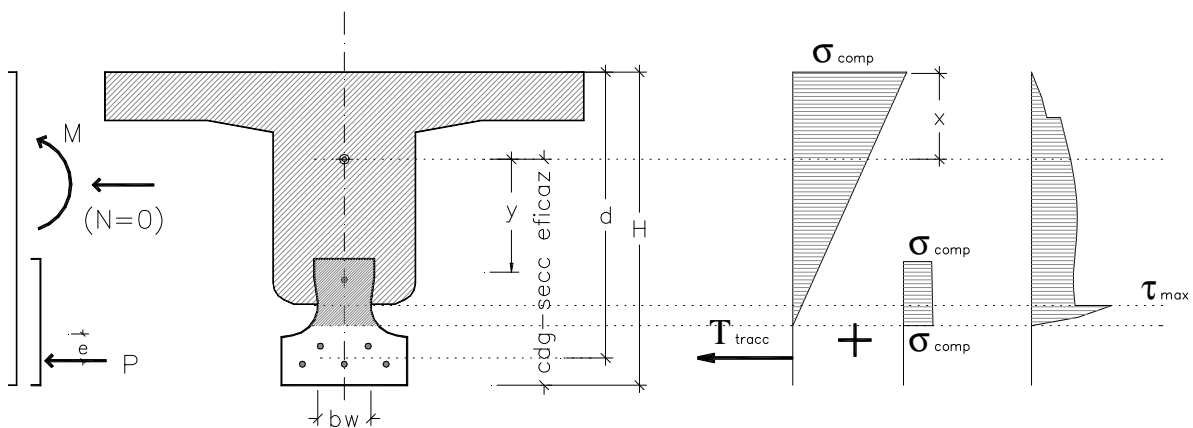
Tensiones en una sección general de un nervio de forjado de viga pretensada. Hormigón fisurado en servicio
